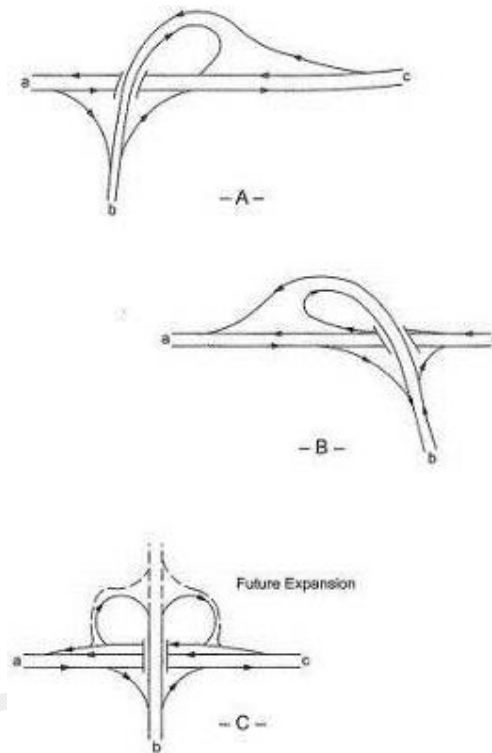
Distribuidores de tres ramales con estructuras simples
